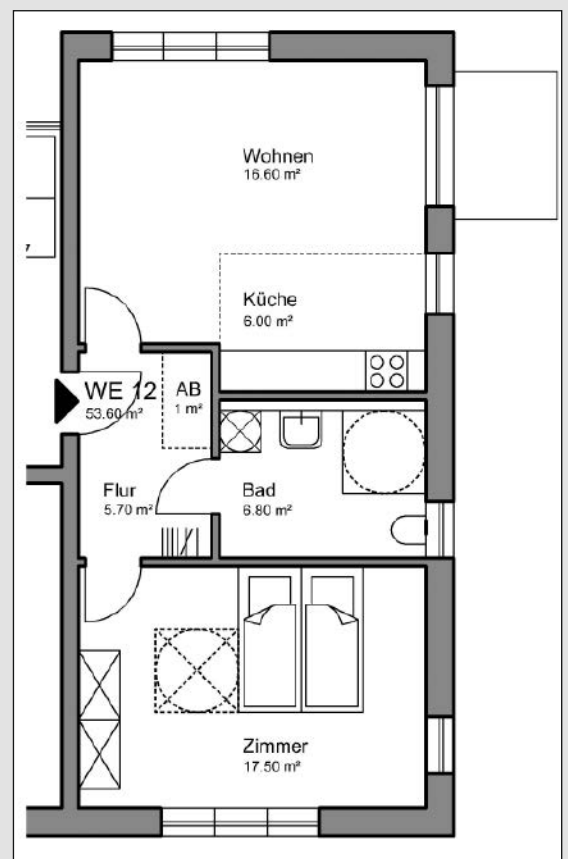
Beispiel Grundriss Einpersonenhaushalt
